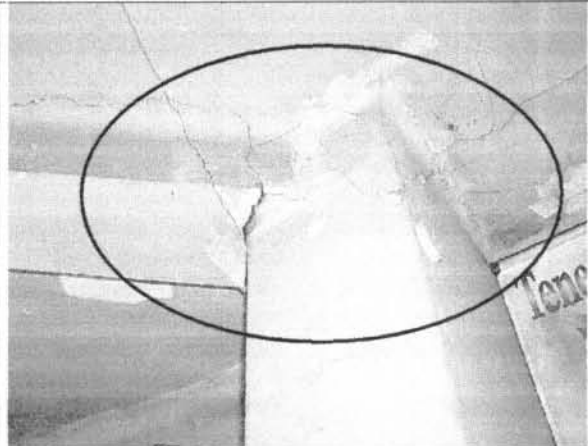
Hay grietas en el nudo de unión viga - columna, en el costado norte del inmueble - Placa Piso 2.
